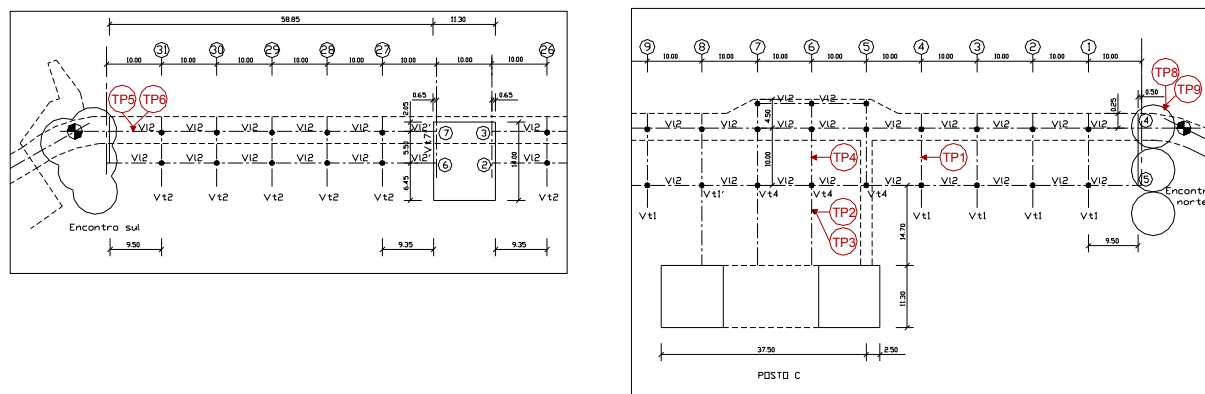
Planta do viaduto do Terminal de Petroleiros – Localização das amostras retiradas das vigas, laje e encontro (TP1, TP2, TP3, TP4, TP5, TP6, TP8 e TP9).
